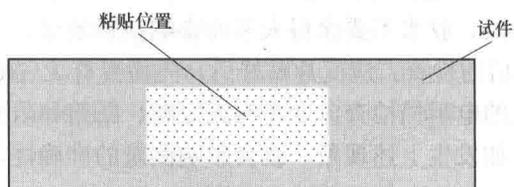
钢筋混凝土梁应变片粘贴处表面处理示意图
